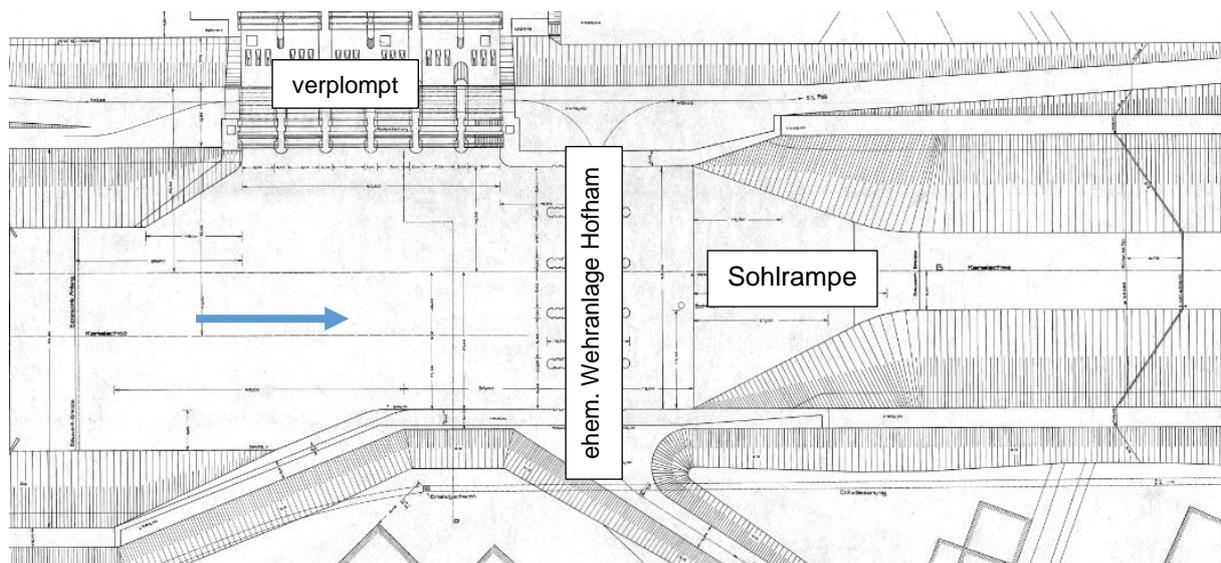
Lageplan ehem. Wehranlage Hofham mit Uferwänden und Sohlrampe (Archivplan 520) (Q7.1)
